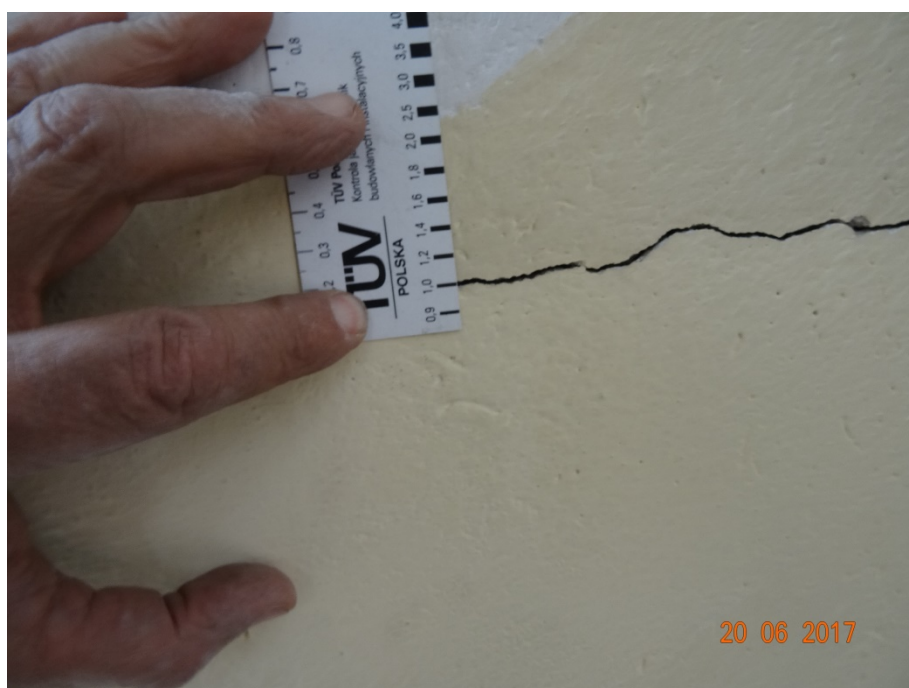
Odkrywka lewa jak na fot. 121. Rysa przebiega przez spoinę poziomą muru.
